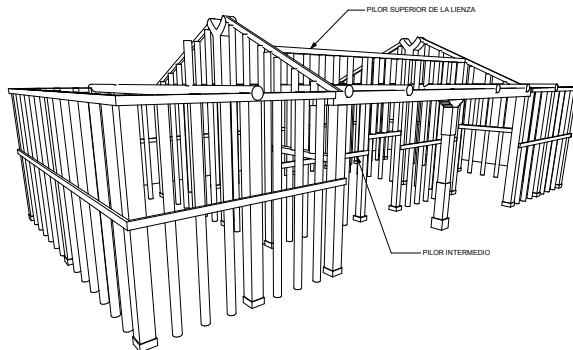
Detalle, estructura superior y la cubierta.
